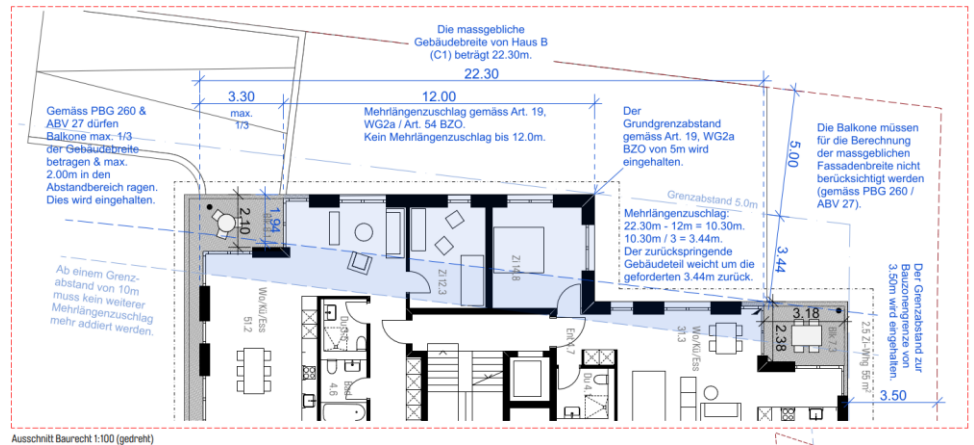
Planausschnitt – Erläuterungen Baurecht Haus B (C1), Quelle: Ramser Schmid Architekten
